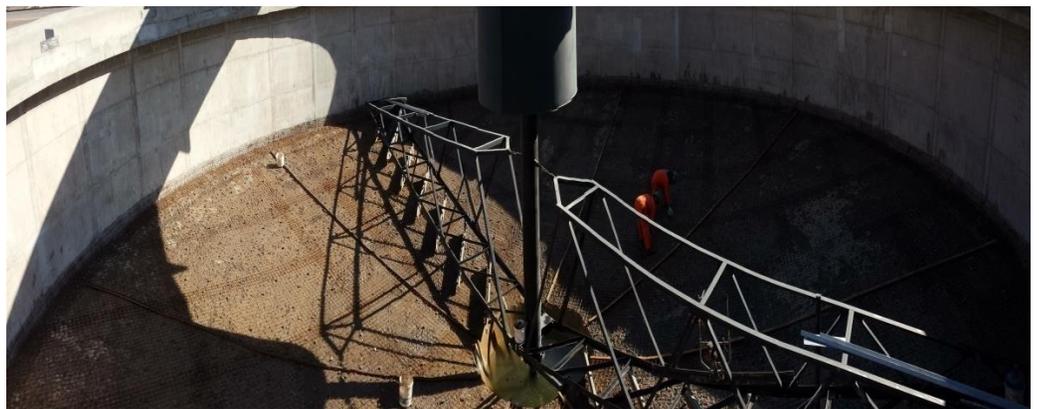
Espesador de lodo previo al hormigonado(fuente: foto tomada durante la práctica)
